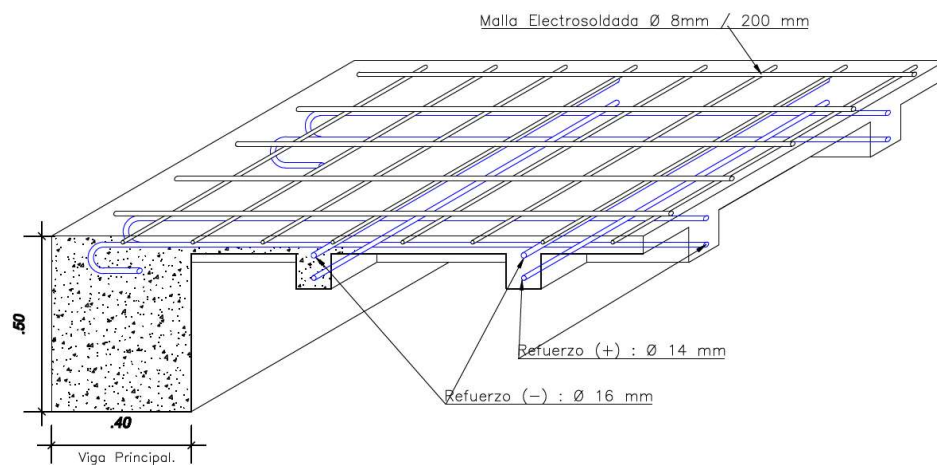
Losa de planta baja, 1er, 2do, 3er y 4to Nivel.
